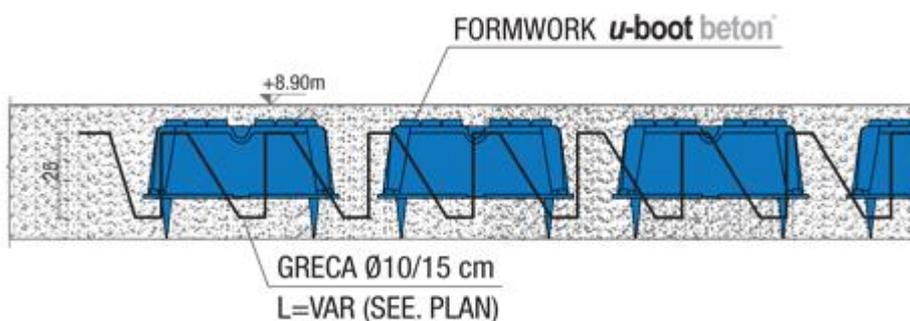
COUPE DE UBOOT BETON PLANCHAIT
